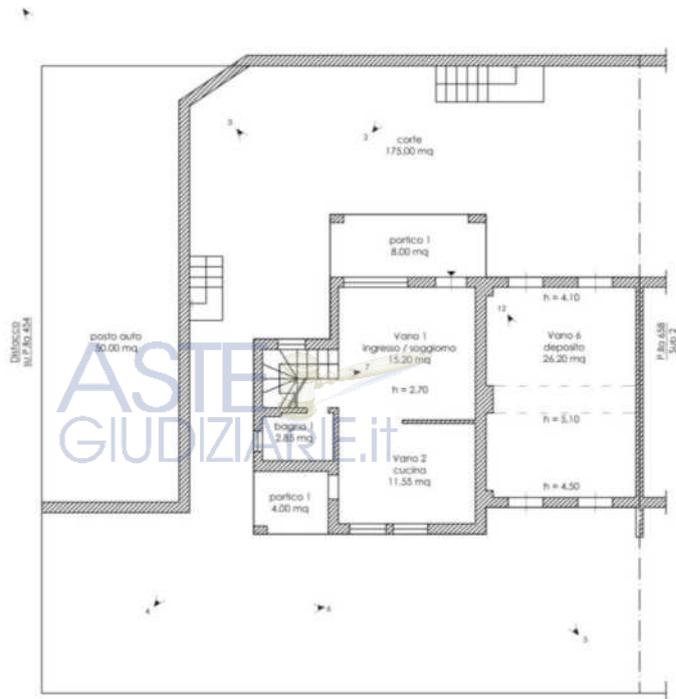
Schema planimetrico piano T come da allegato 8a alla presente relazione.
